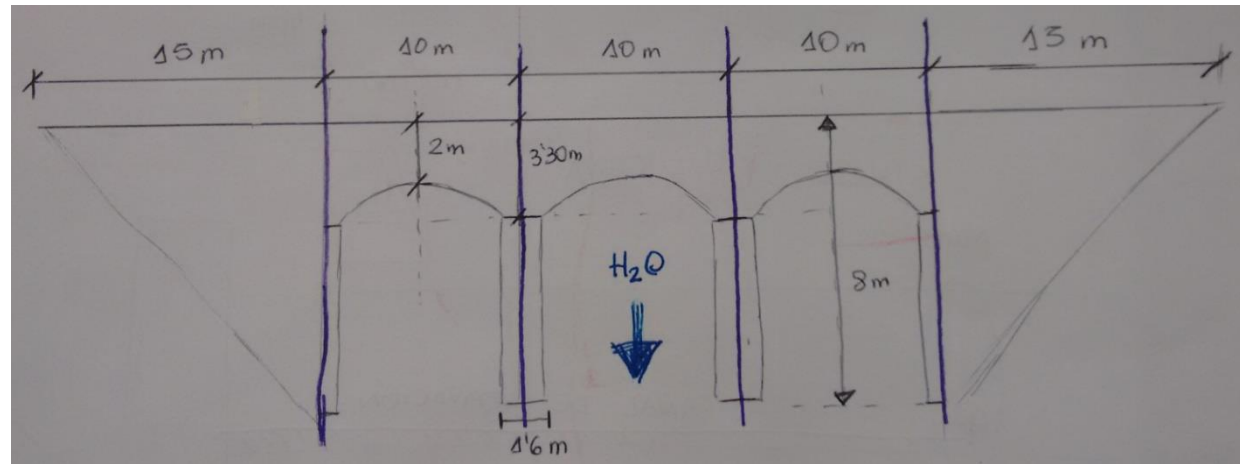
Croquis del alzado del puente (Fuente: Fotografía propia)
